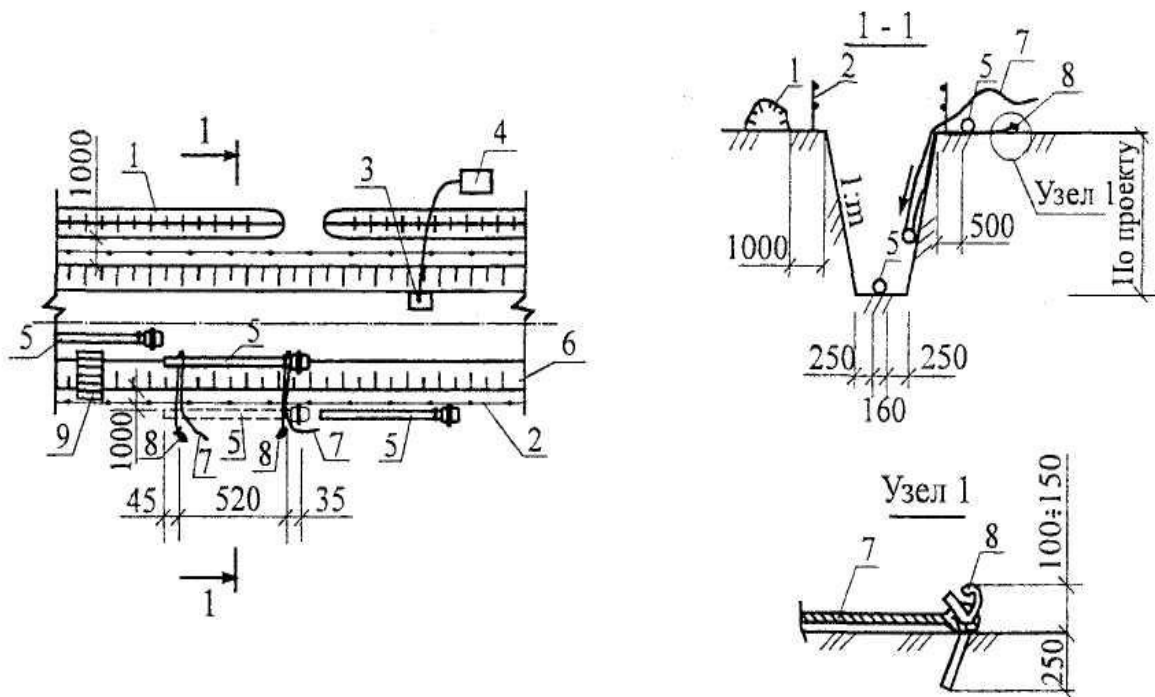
Схемы разгрузки и опускания ПВХ труб в траншею
